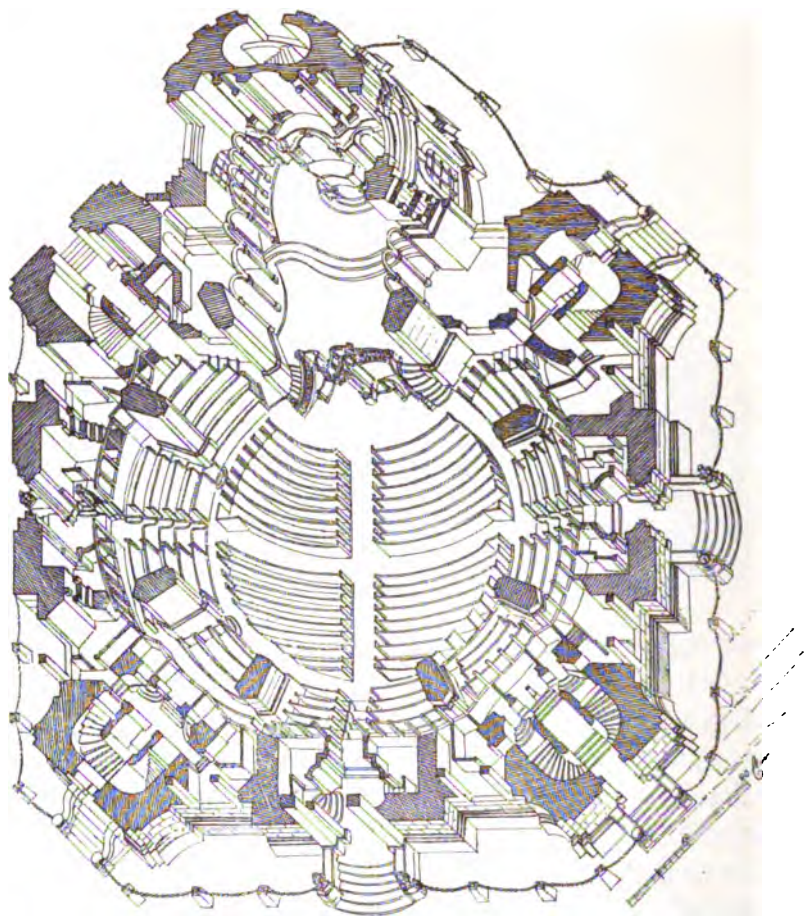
Grundriss der Frauenkirche in Dresden.
